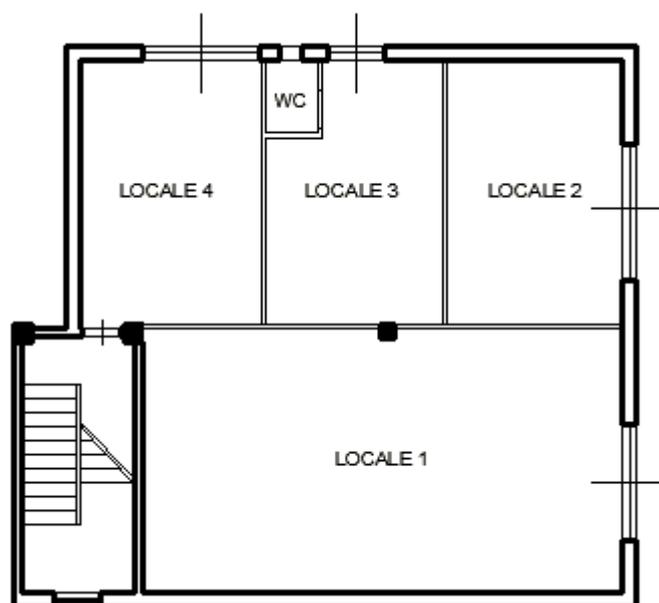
Schema planimetrico dello stato reale dell'immobile sub. 10
